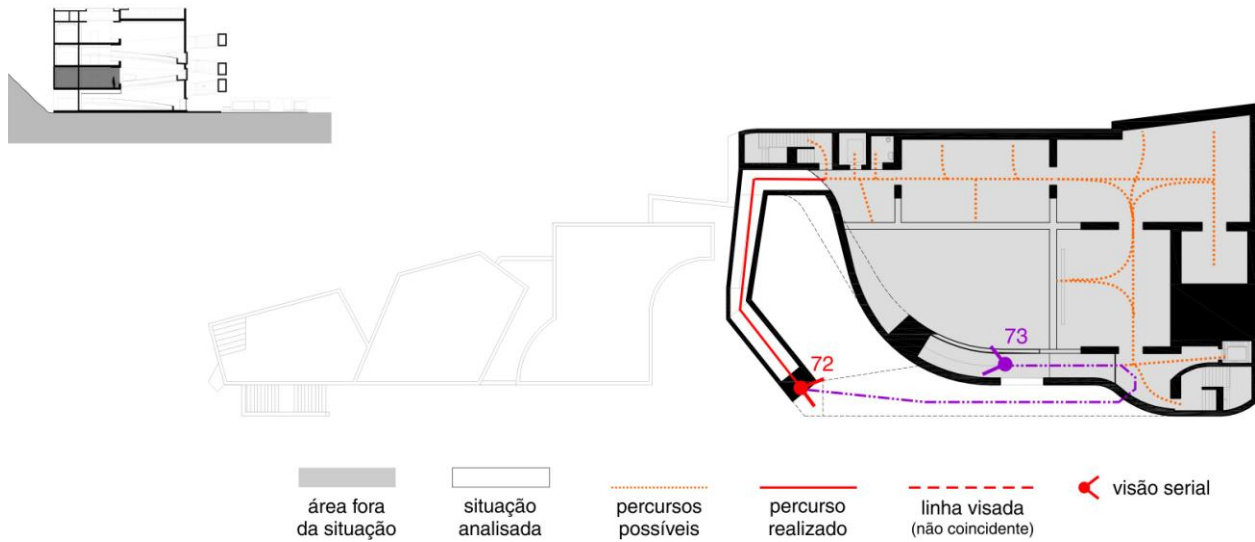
| FIC – Planta Segundo Pavimento | Desenho da Autora
